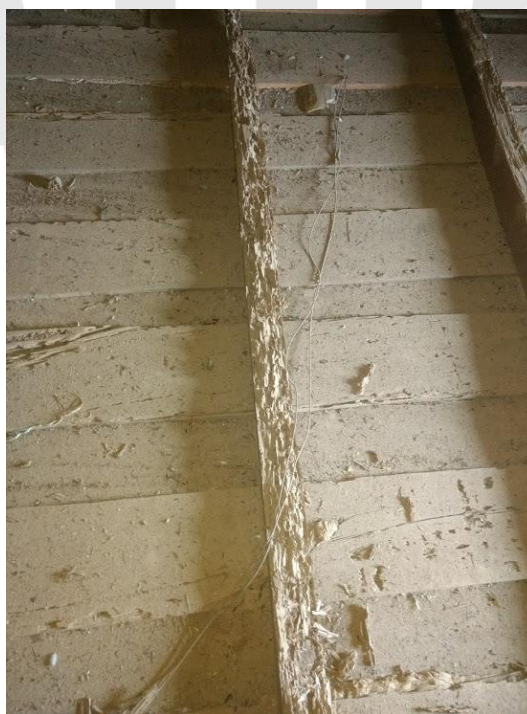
Detalhe do madeiramento deteriorado do telhado.
